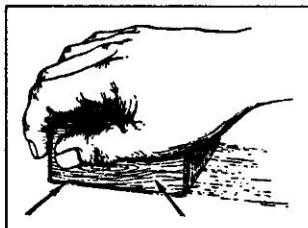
Шлифовка шпаклеванной или окрашенной поверхности шкуркой
